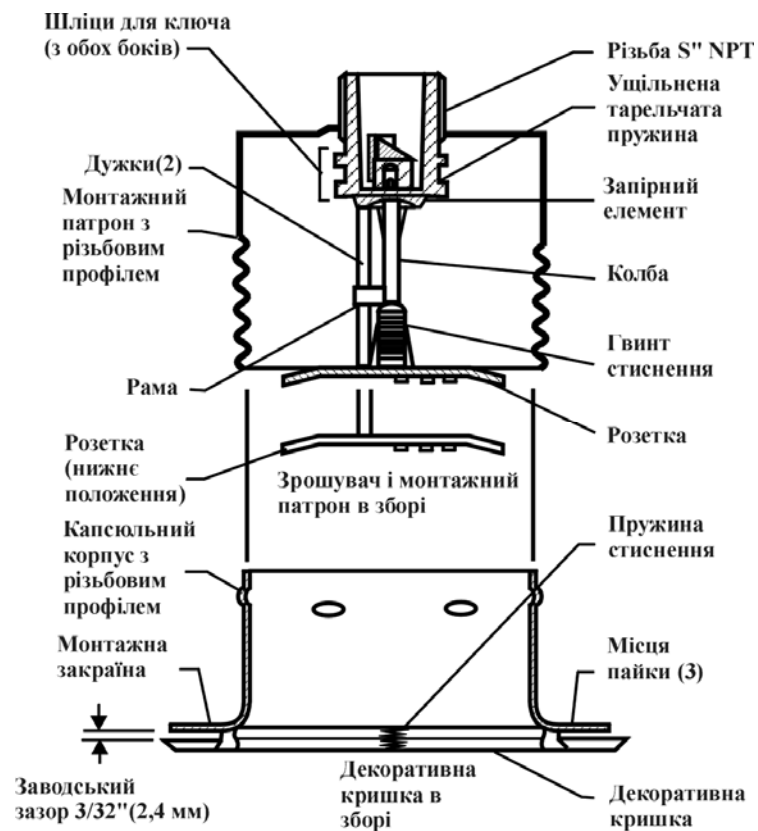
Спринклерний зрошувач тасмний, стандартного реагування розеткою до низу (для установки під підвісну стелю)
